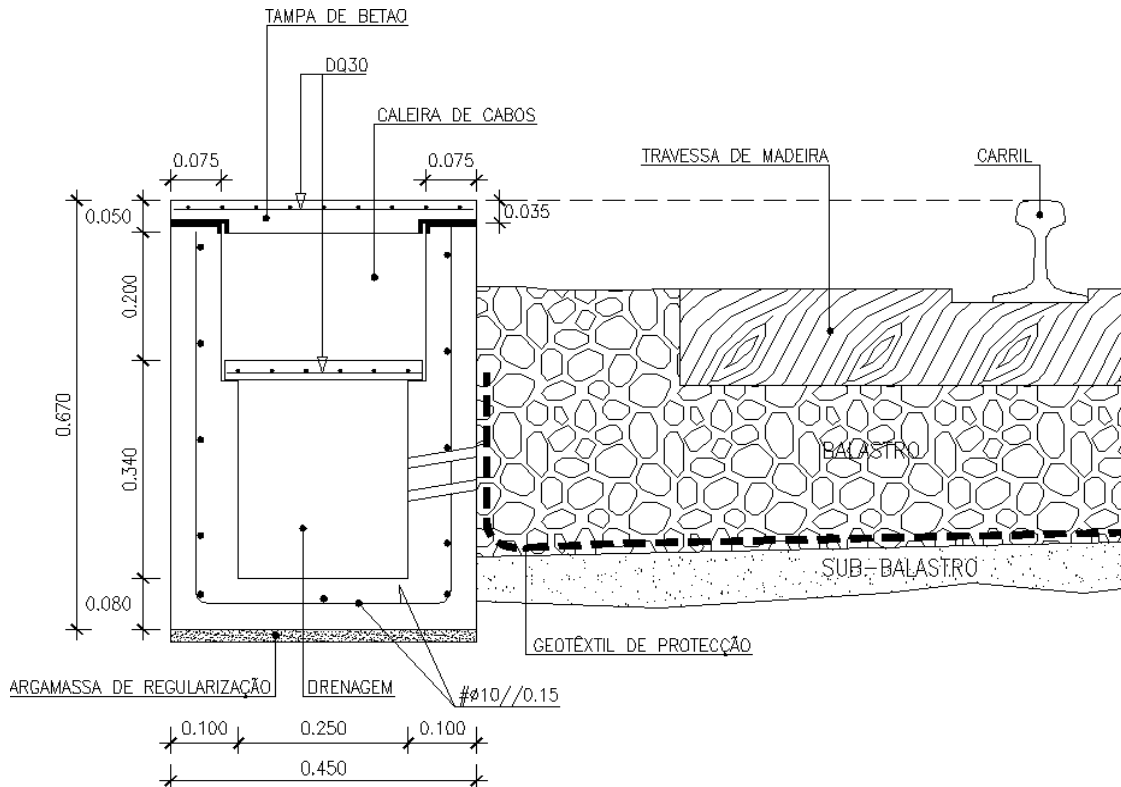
Monobloco pré-fabricado em betão armado para drenagem de águas e caminho de cabos (pormenor), (GEG)
